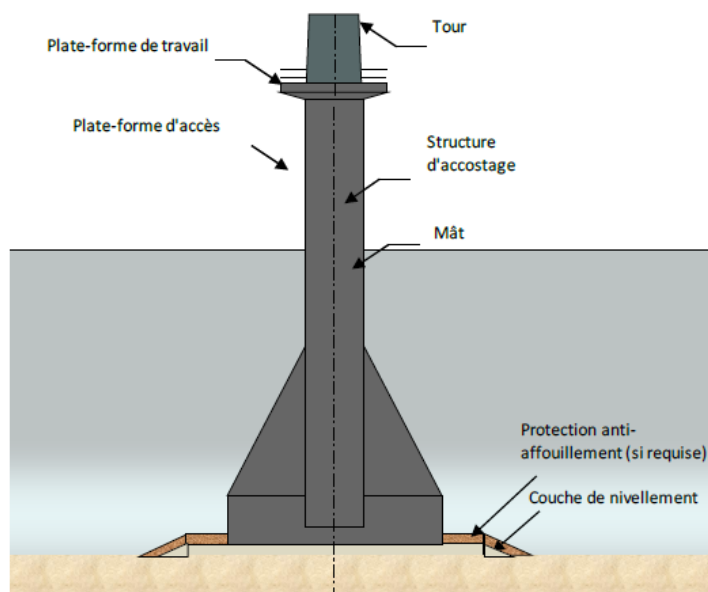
Schéma d'une fondation à structure embase gravitaire
